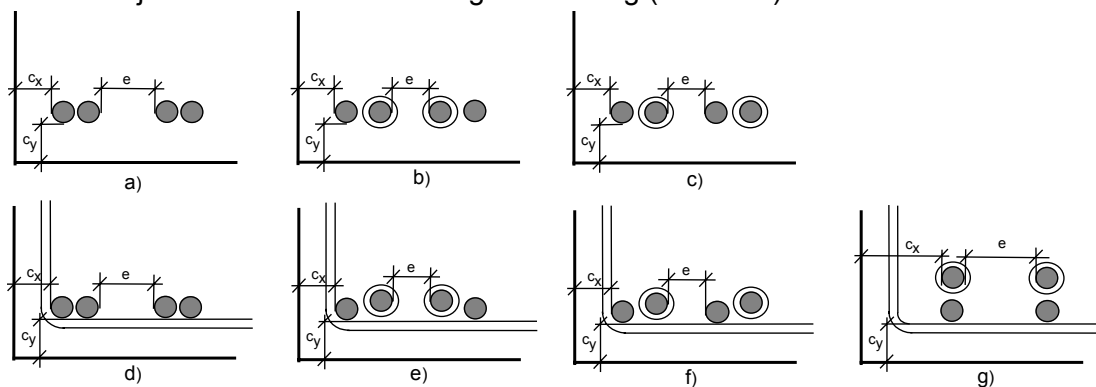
Betondeckung und lichter Abstand der eingemörtelten und einbetonierten Bewehrung; schematische Darstellung
